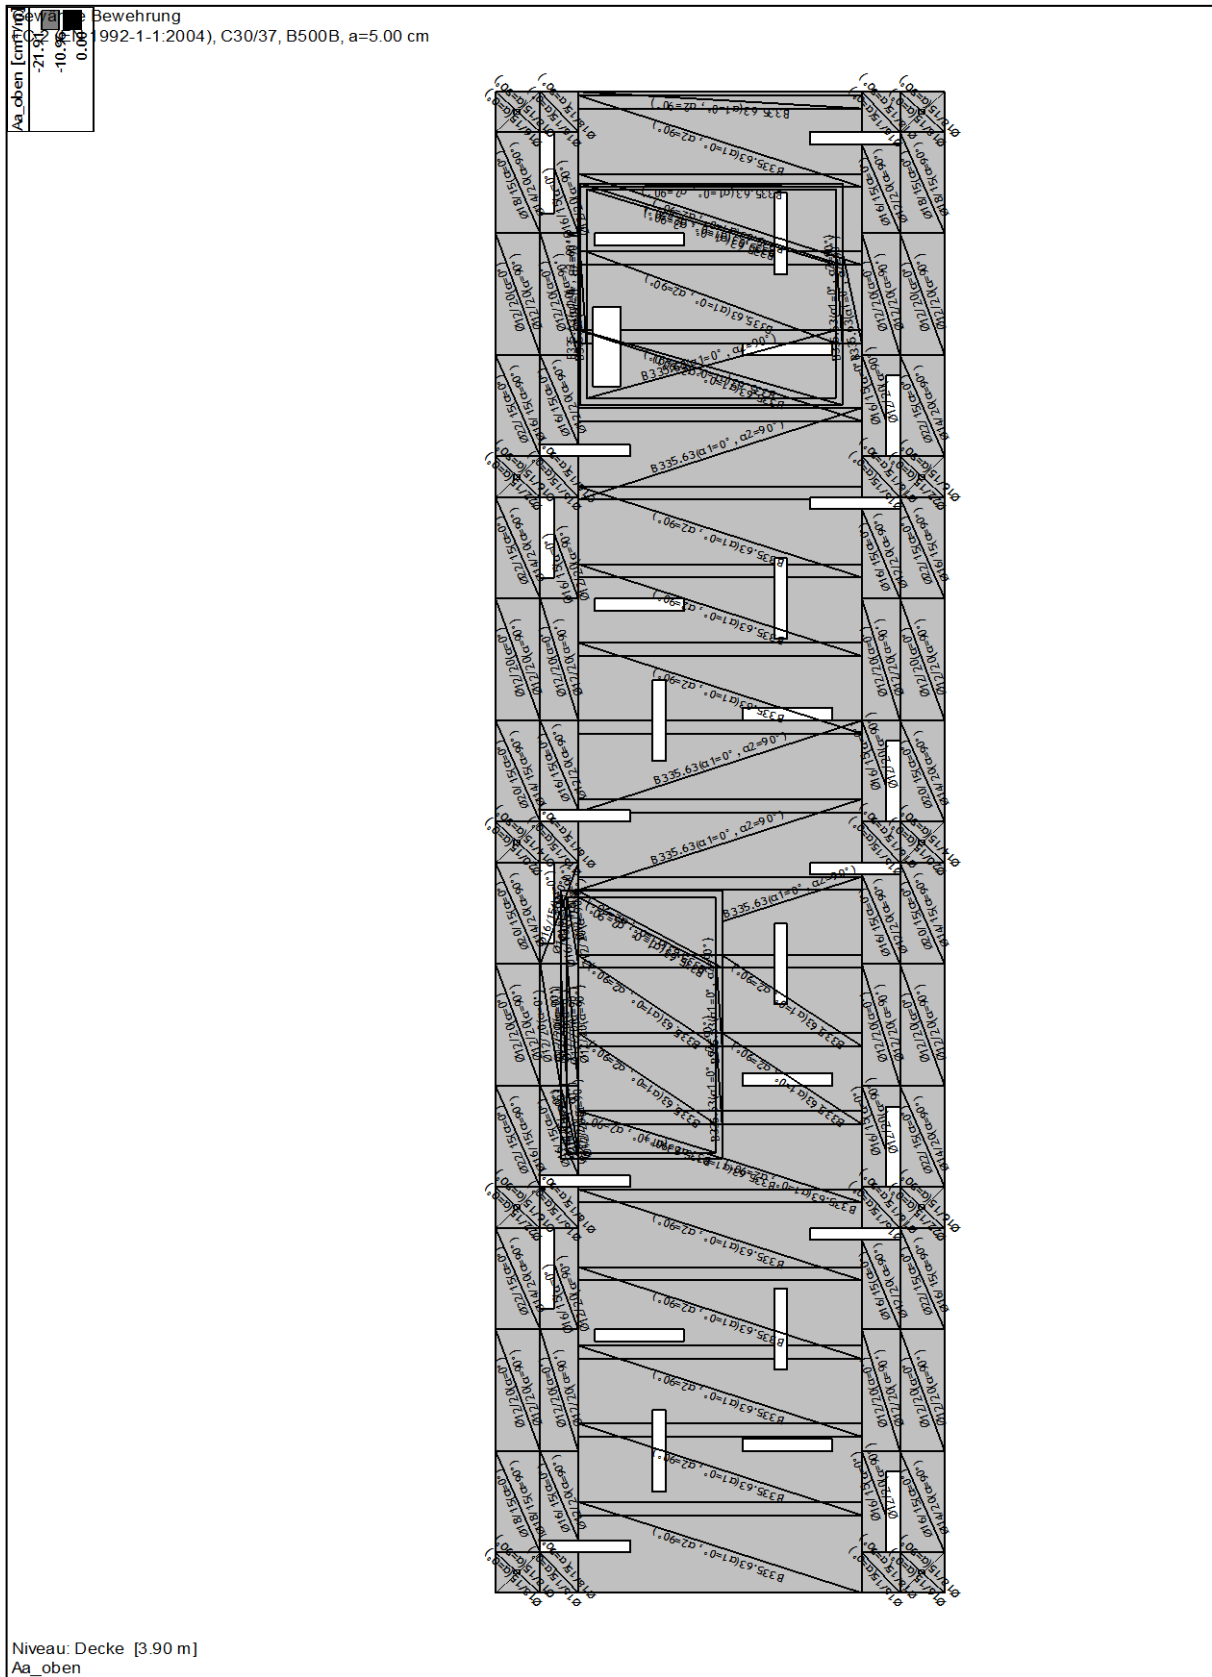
Bestehende obere Bewehrung – Dachplatte
